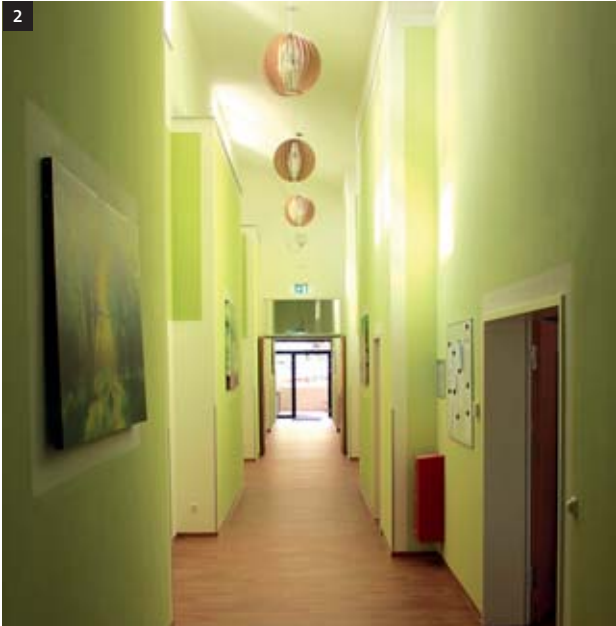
Für die zwölf barrierefreien Mikroapartments mit Badezimmer und Wohnbereich mussten durch den Einsatz der dezentralen Lüftung bei der Planung keine besonderen Brandschutzmaßnahmen berücksichtigt werden
